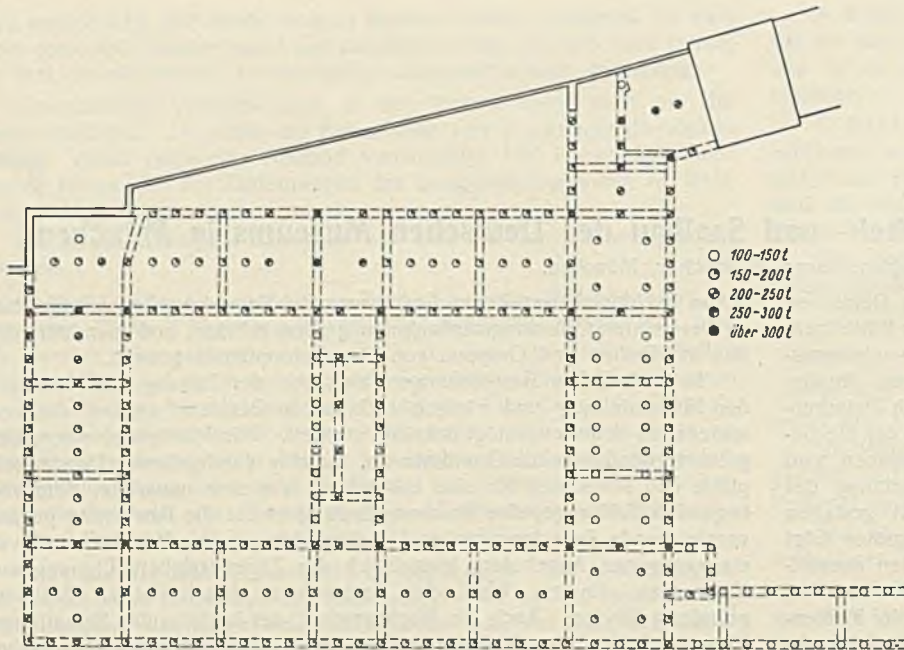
Lageplan der Brunnengründung für den Bibliotheksbau.
